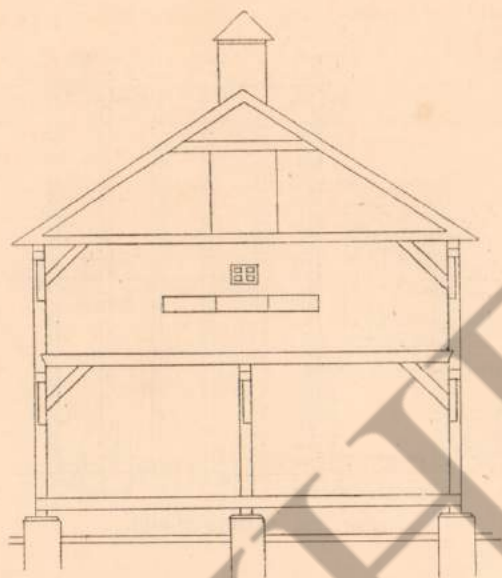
Поперечный разръзъ сушильни (остовъ здания).
